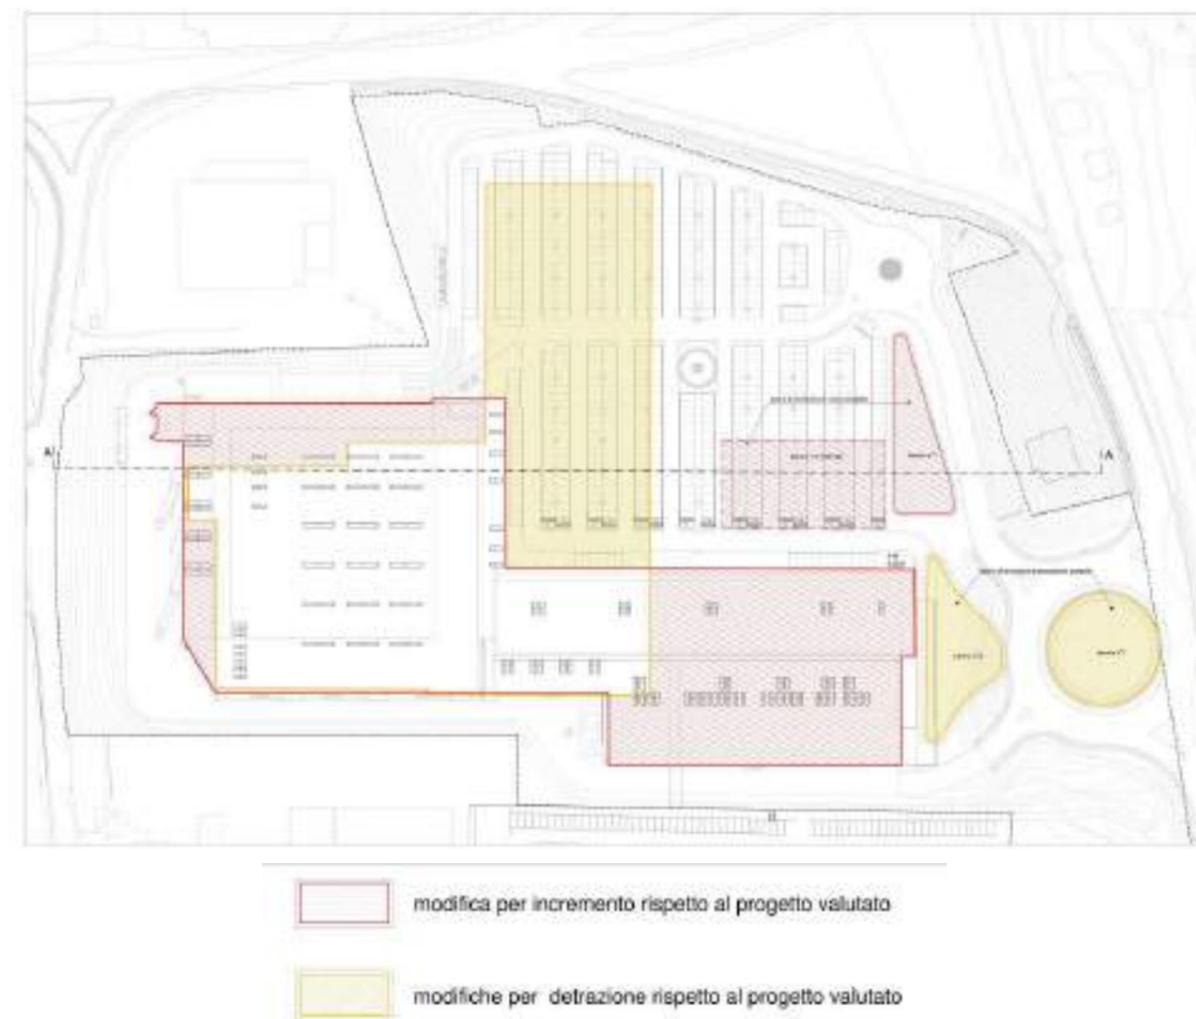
Raffronto: principali modifiche rispetto progetto valutato (sagome edilizie e bacini di laminazione)
